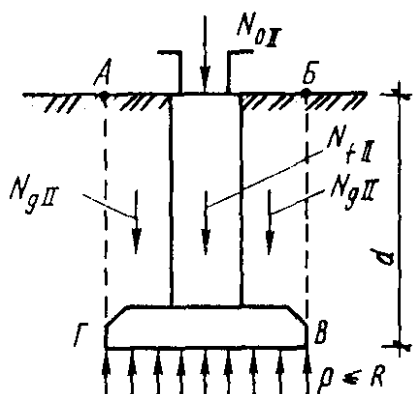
Расчетная схема центрально нагруженного фундамента
